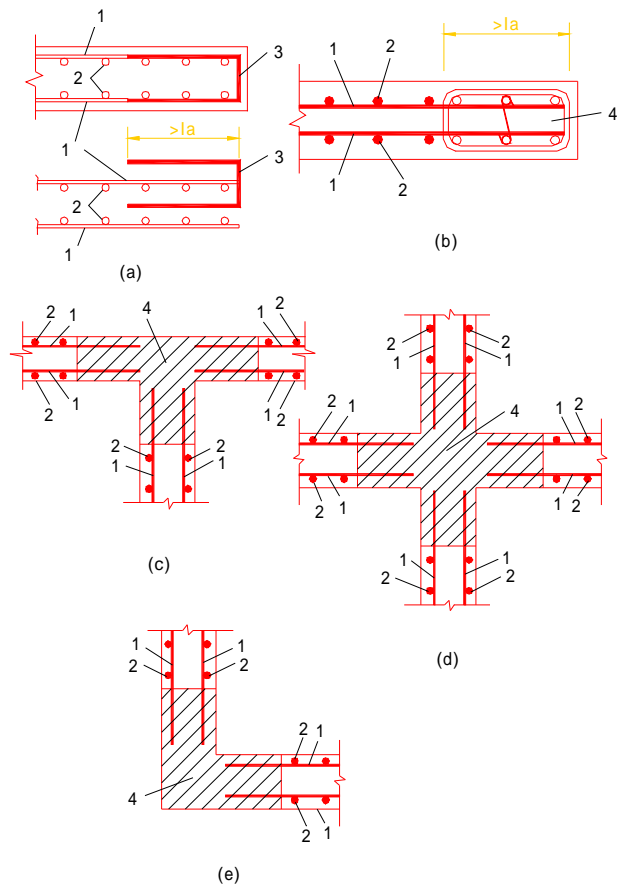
钢筋焊接网在墙体端部的构造
